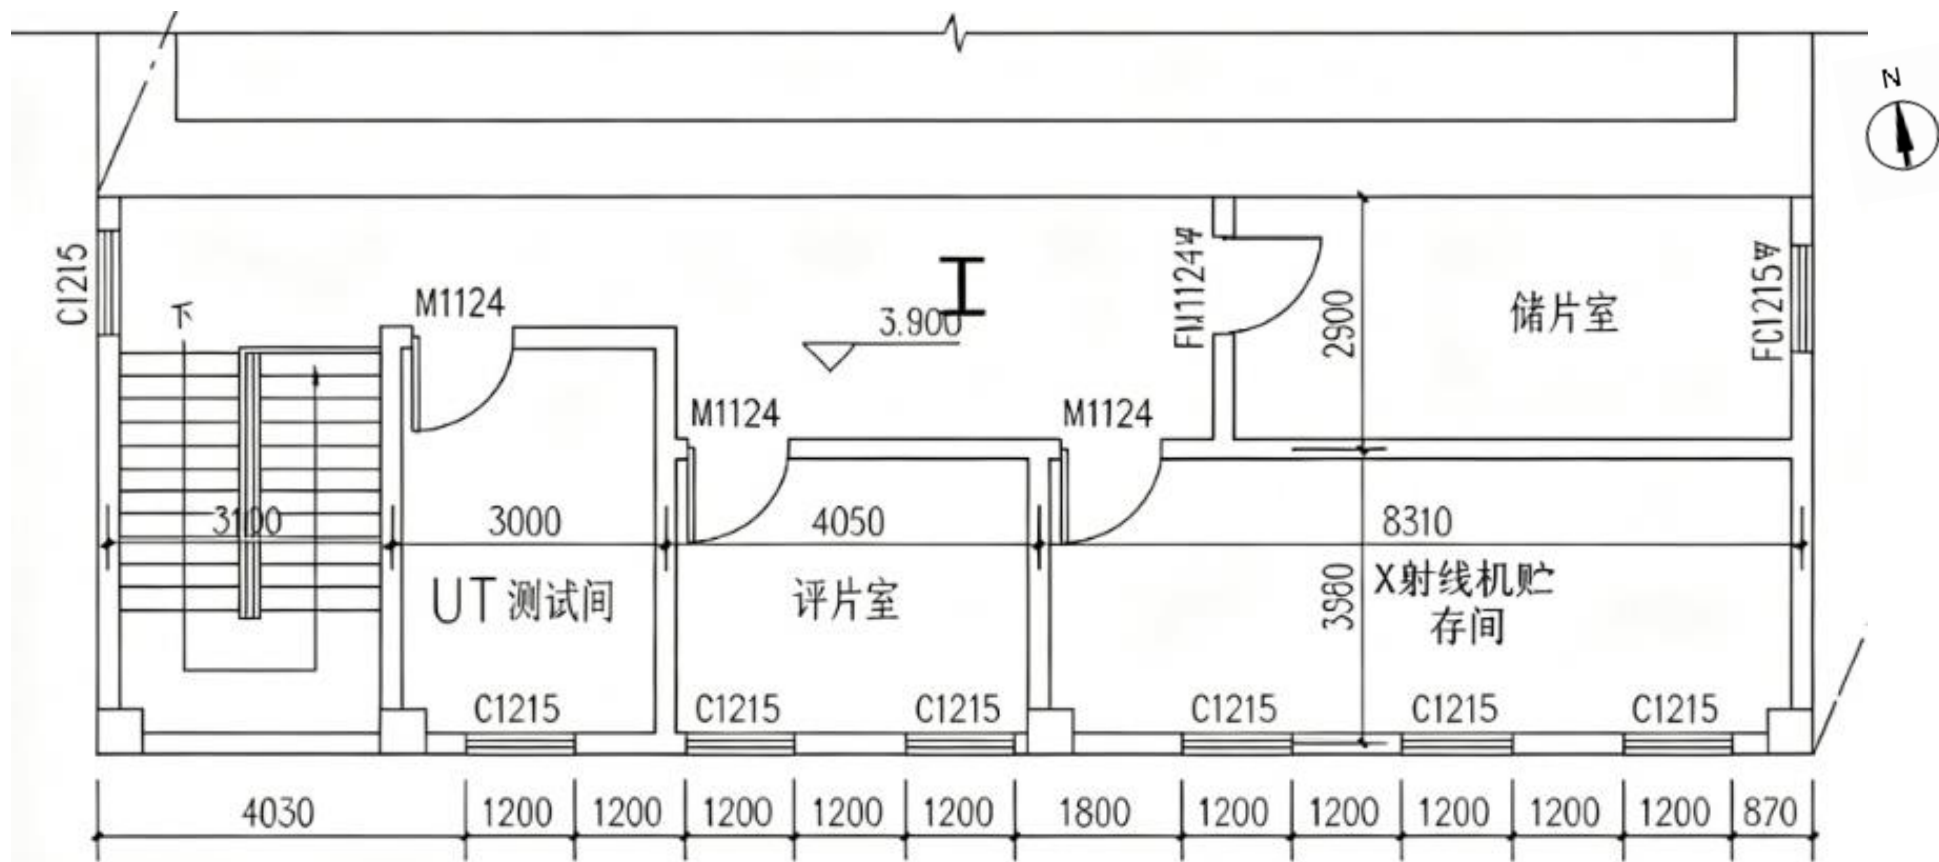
探伤室及放射源暂存库平面布置图（二层）
